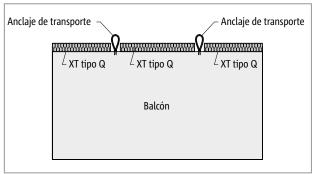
Schöck Isokorb® XT tipo Q: Balcón de elementos con anclaje de transporte; in situ se puede colocar el adaptador aislante XT tipo Z
